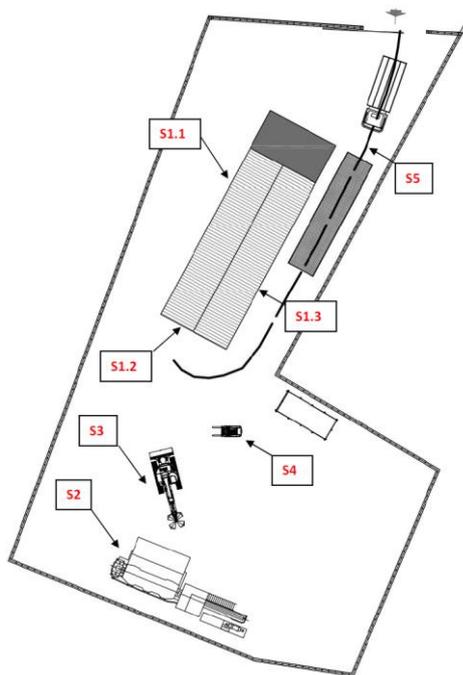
Layout impianto con individuazione delle sorgenti emissive
